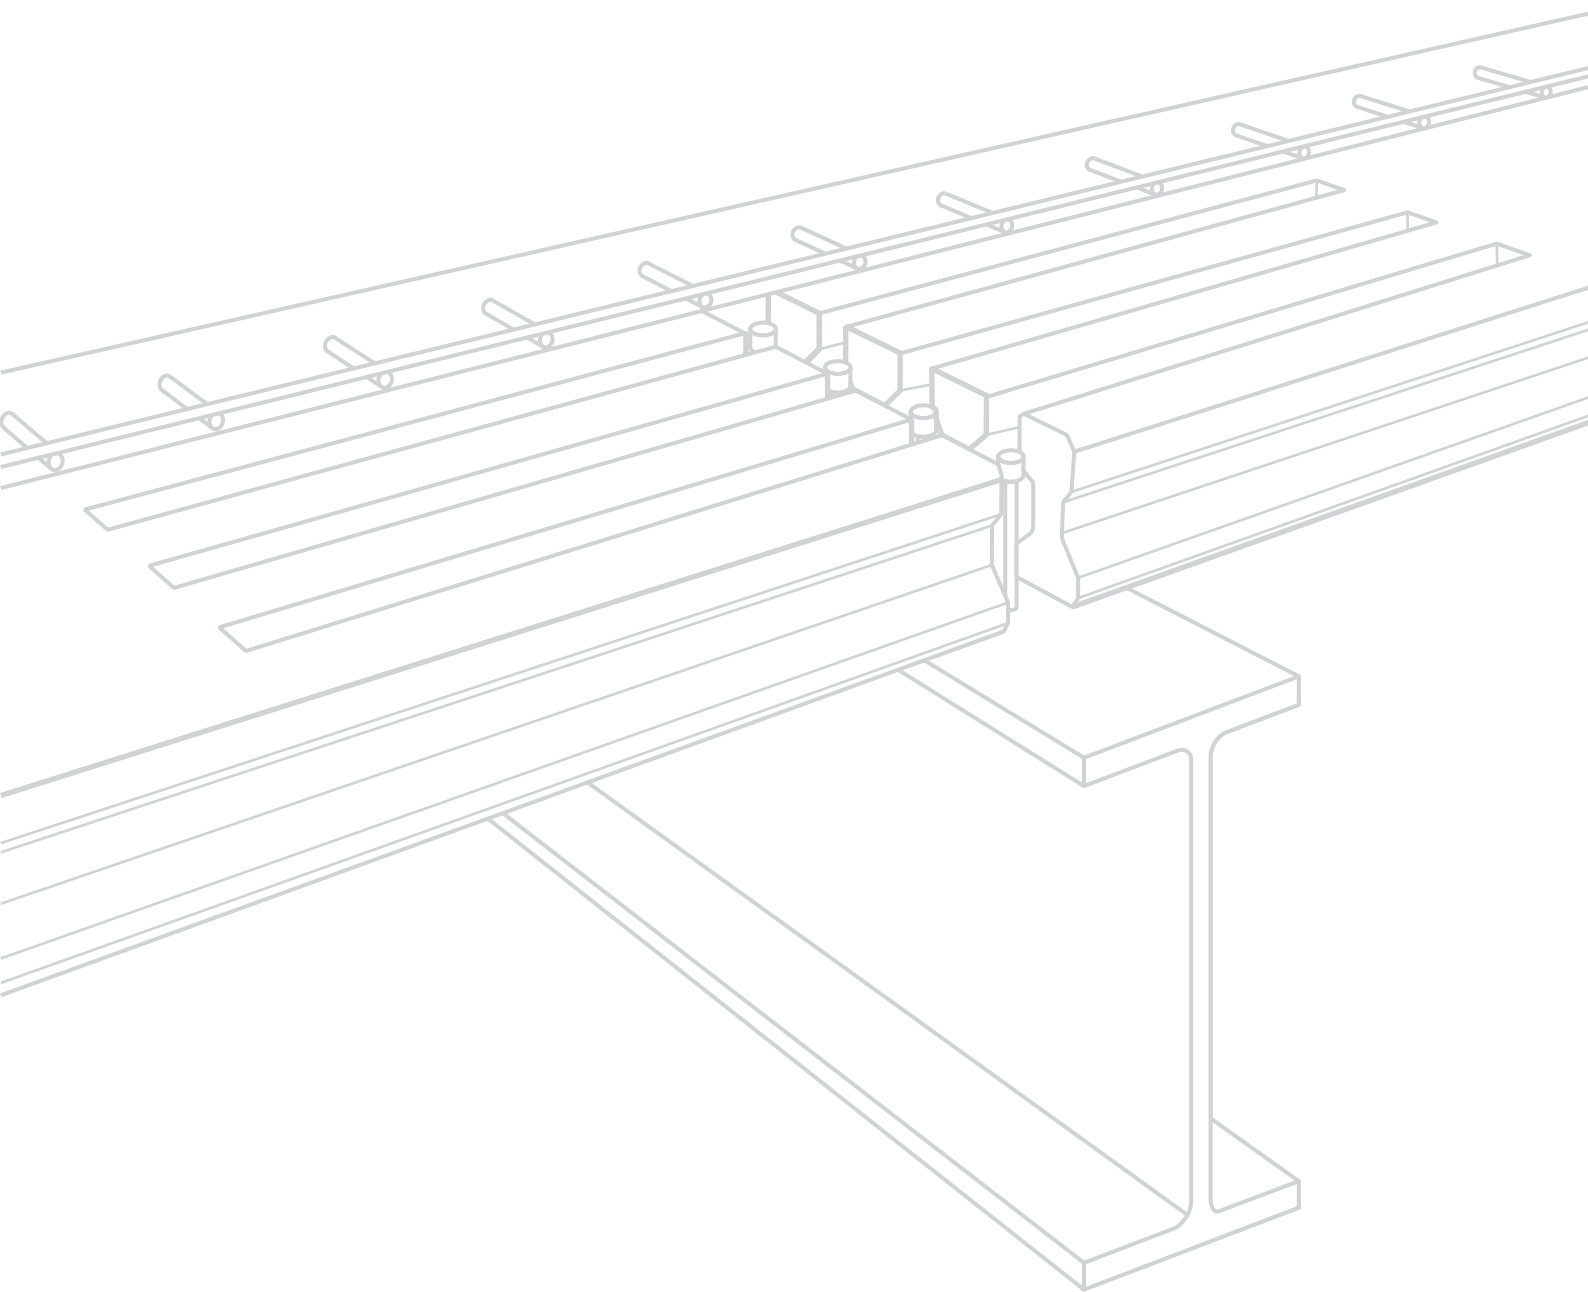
Sistema misto de vigas de aço e lajes alveolares
